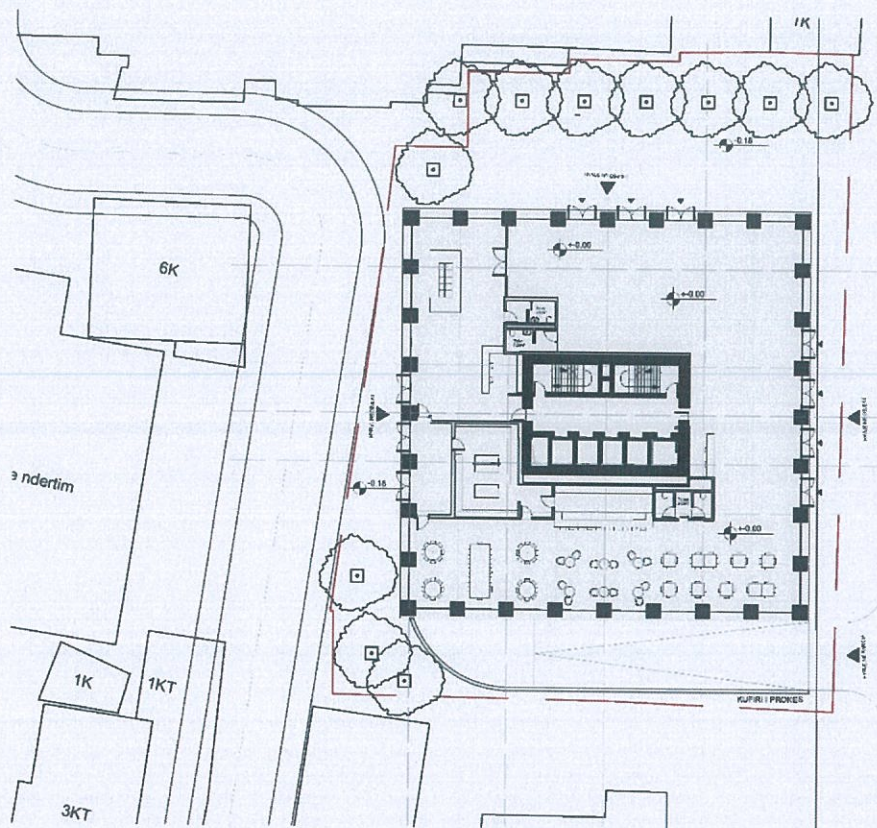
Planimetria e katit përdhe, në kuotën +0.00
